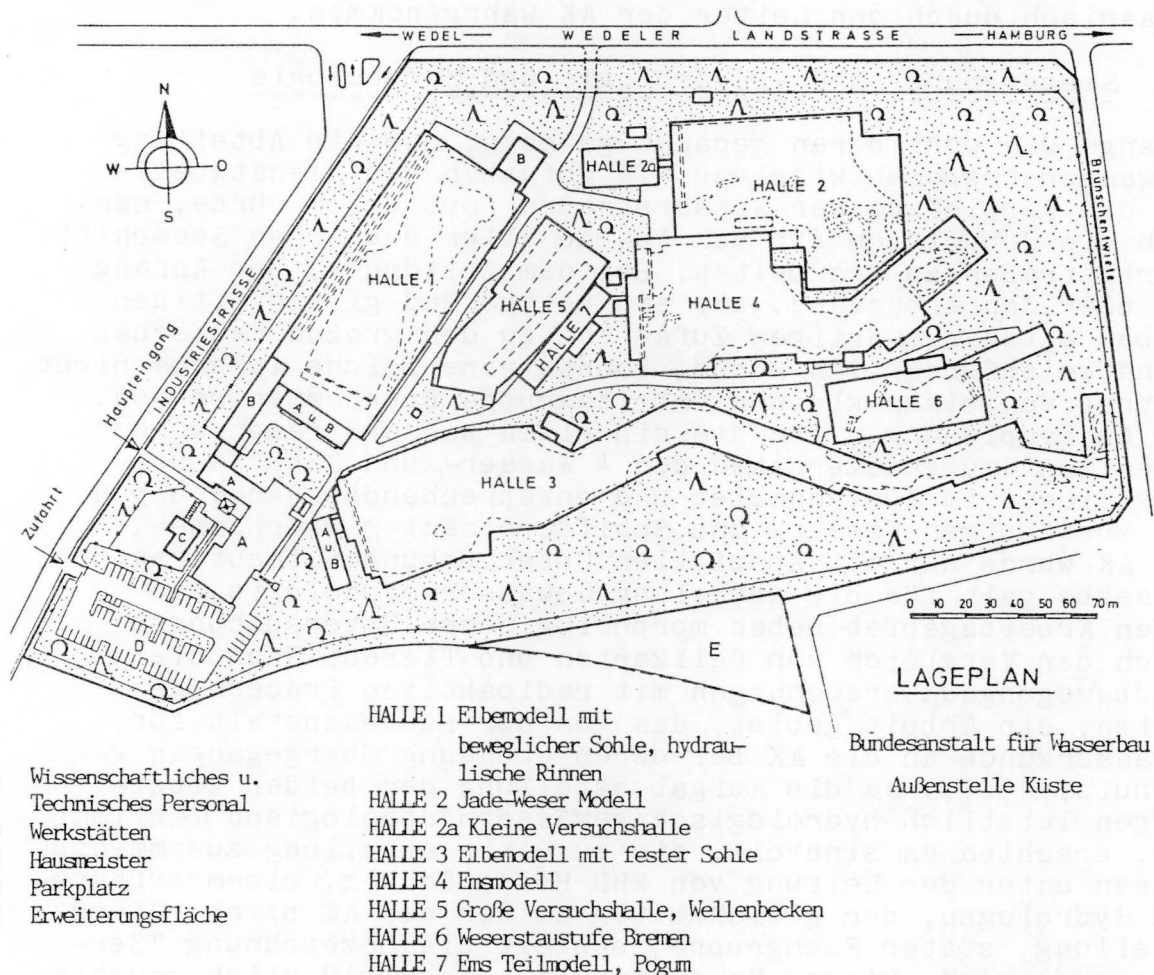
Lageplan des Geländes der "Außenstelle Küste" in Hamburg-Rissen. Zustand 1986
